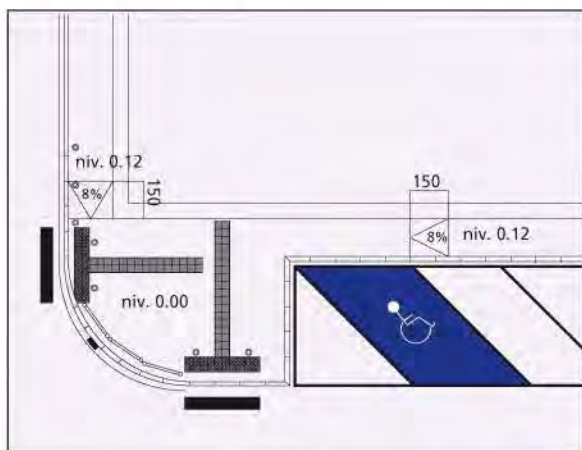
vue en plan d'une inflexion généralisée. © GAMAH
